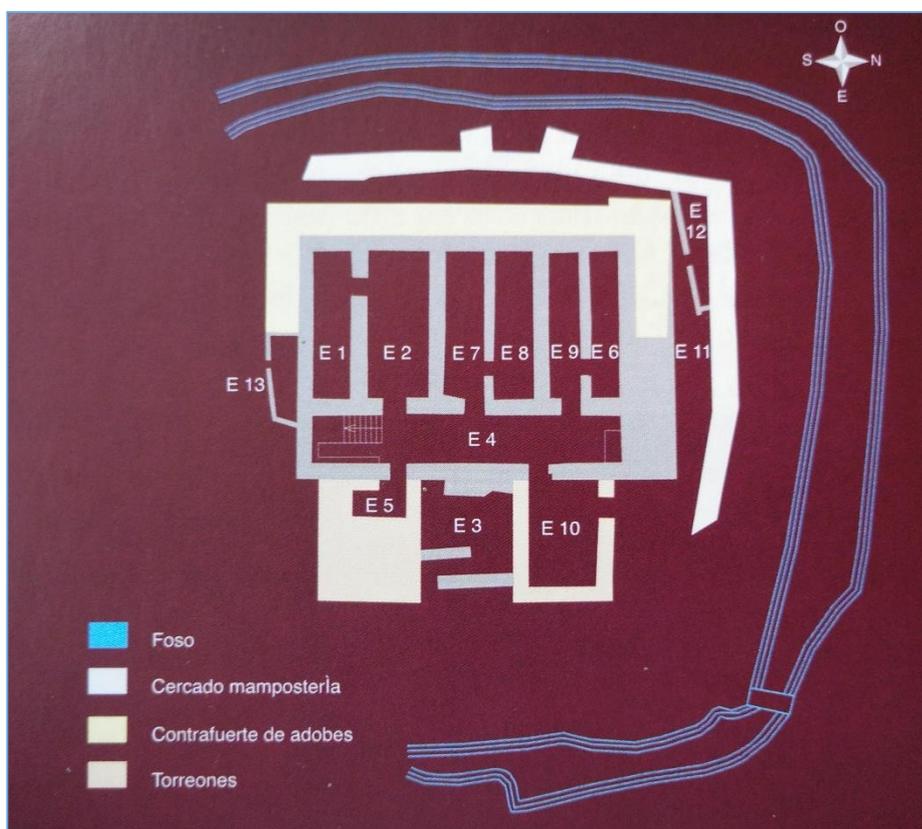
Planta del yacimiento de La Mata (Foto obtenida del folleto de la Oficina de turismo de la Serena)
